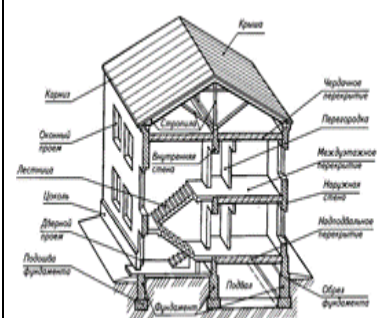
Конструктивные элементы малоэтажного здания
